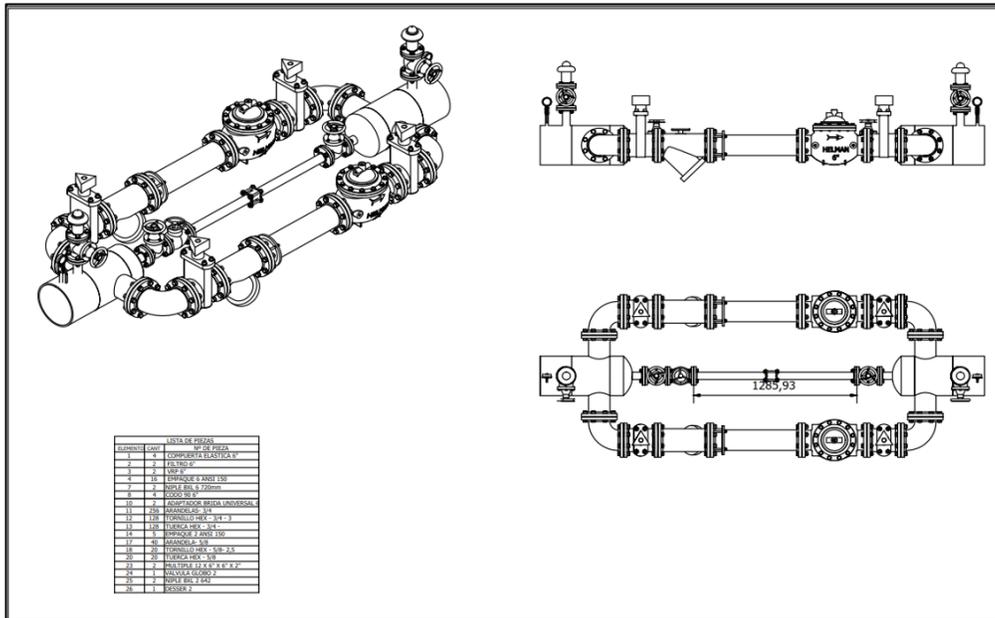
Plano As-Built Instalación Mecánica VRP, Fuente: Consultor Constructor
